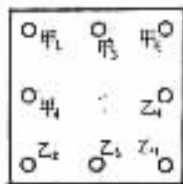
上下柱接头钢筋焊接顺序
